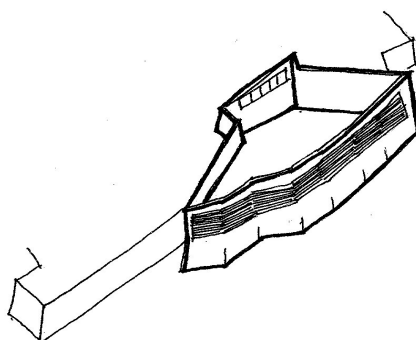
Detalhe esquemático da planta em forma de leque, com janelas elevadas voltadas ao Sul e aberturas zenitais tipo "clerestory" (acima do plano médio do teto).
